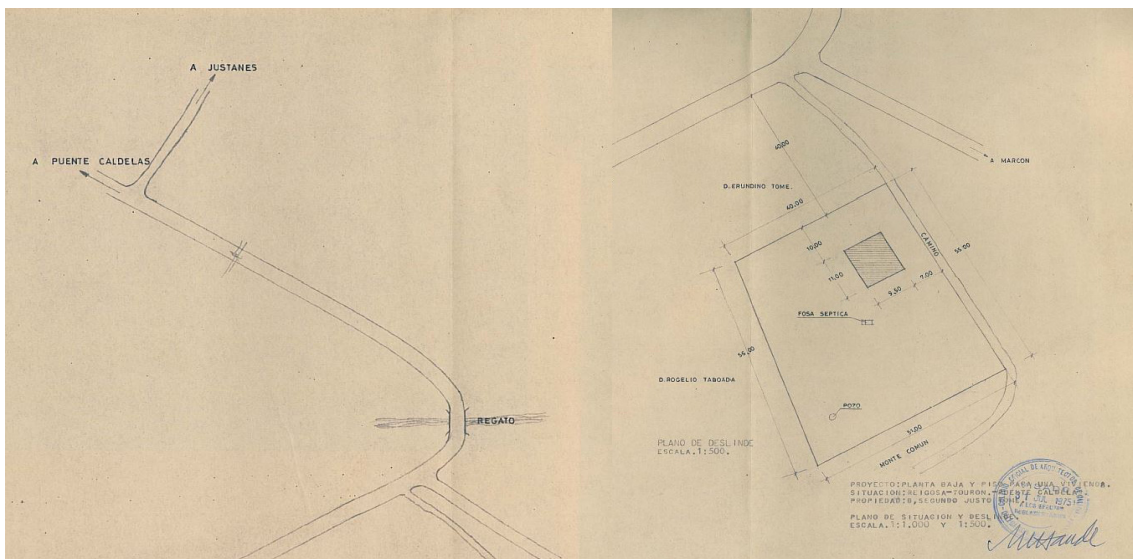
Ejemplo plano de deslinde y situación de un proyecto en Vilarchán año 1975. Fuente archivo municipal.
